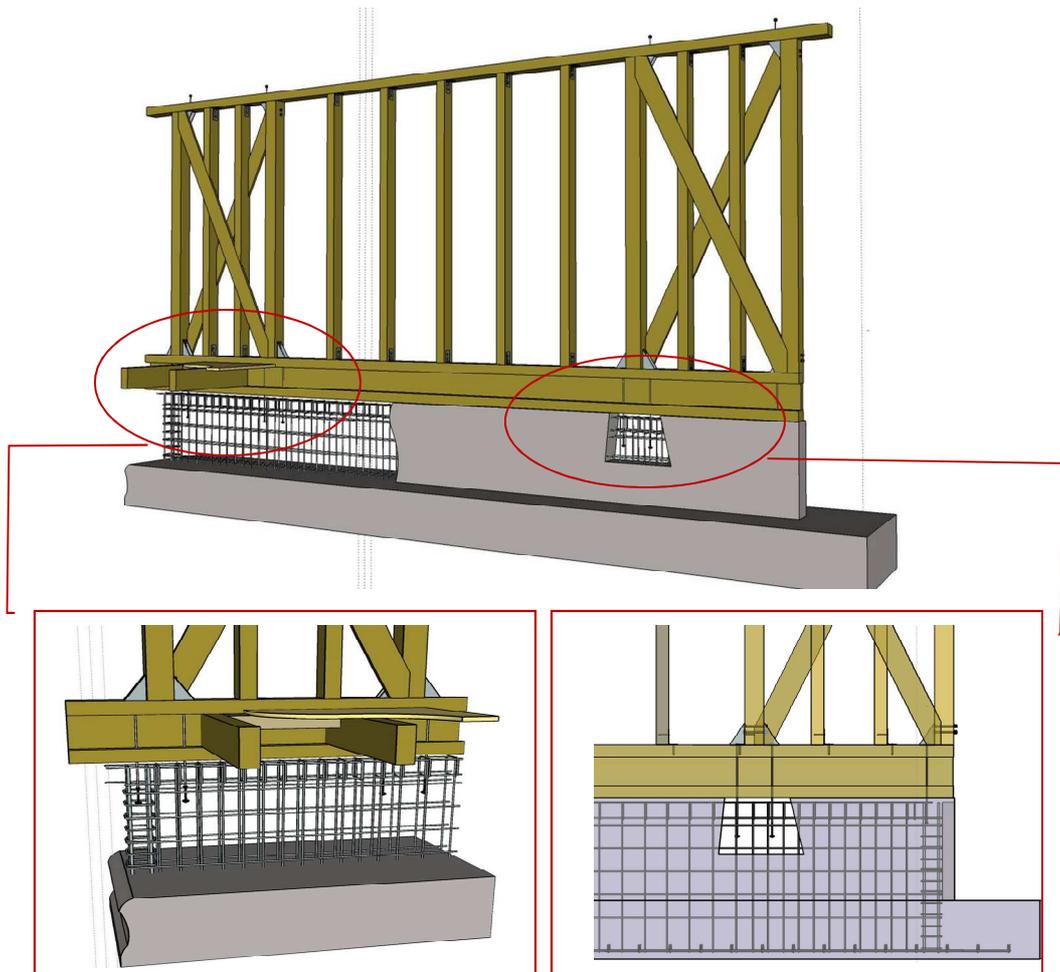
Schémas de principe de l'assemblage (avec réservation)- cas d'un plancher bas en bois
